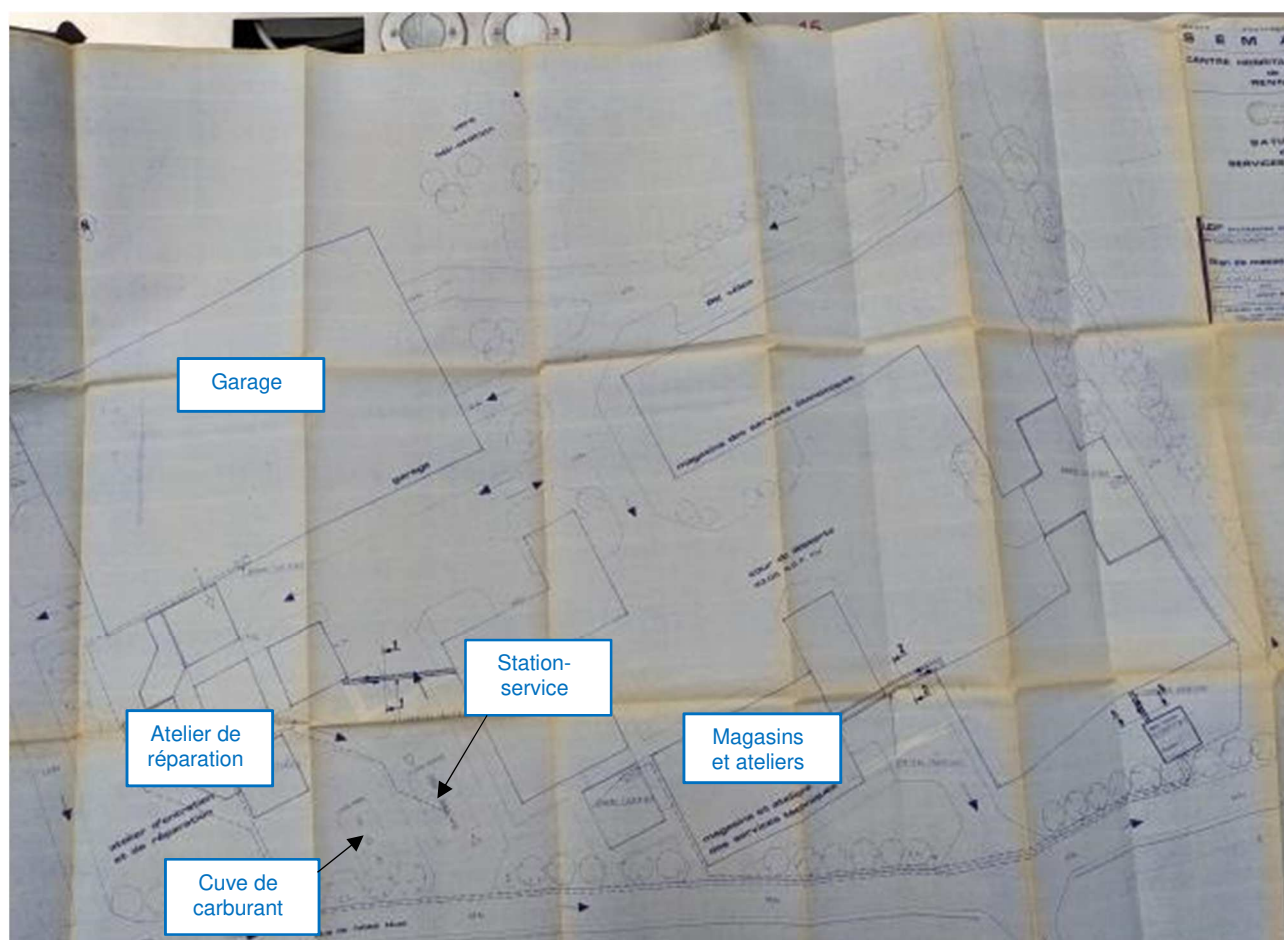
Plan de la zone Nord-Est du site en 1980 (source : archives départementales)
